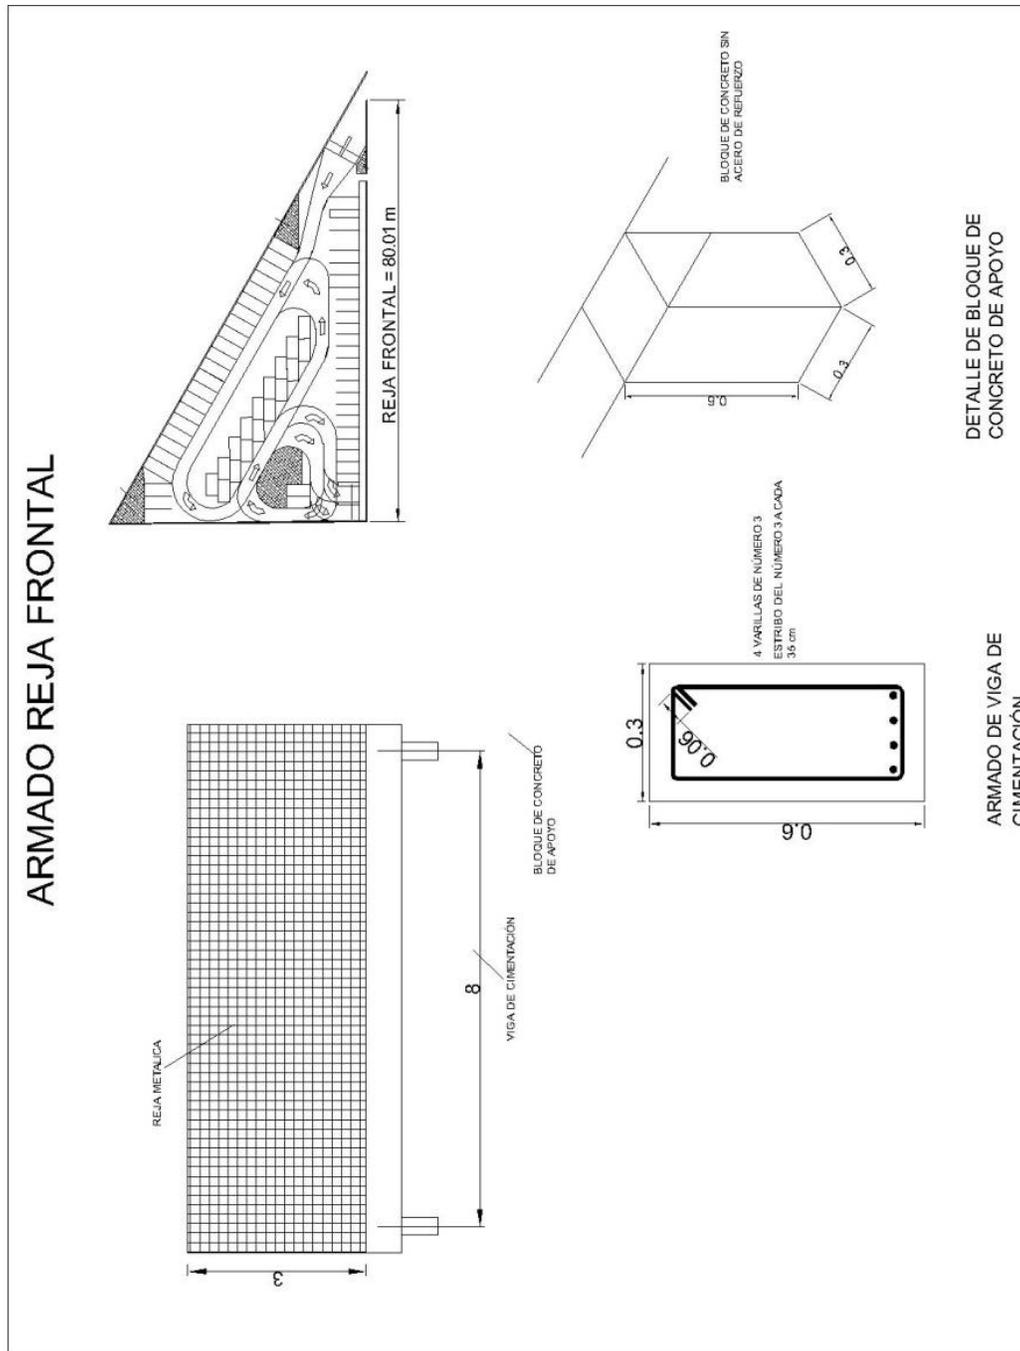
Plano de armado de reja frontal (Fuente: Dibujo hecho por el autor).
